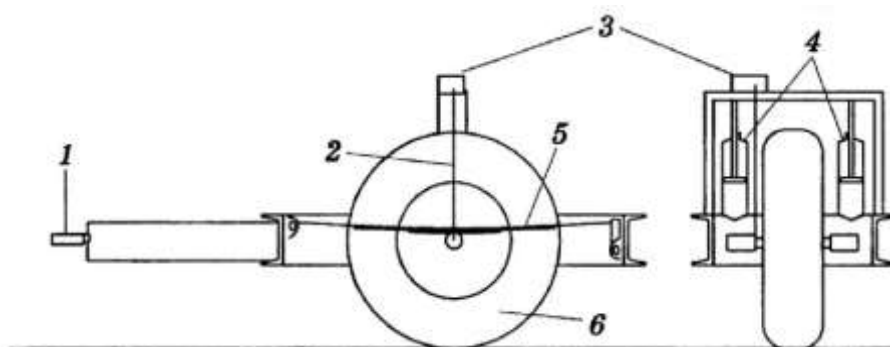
Схема измерителя ровности BPR: 1 – прицепное устройство; 2 – Трос; 3 – дорожный счетчик; 4 – амортизатор; 5 – рессора; 6 – колесо [собственный материал]
